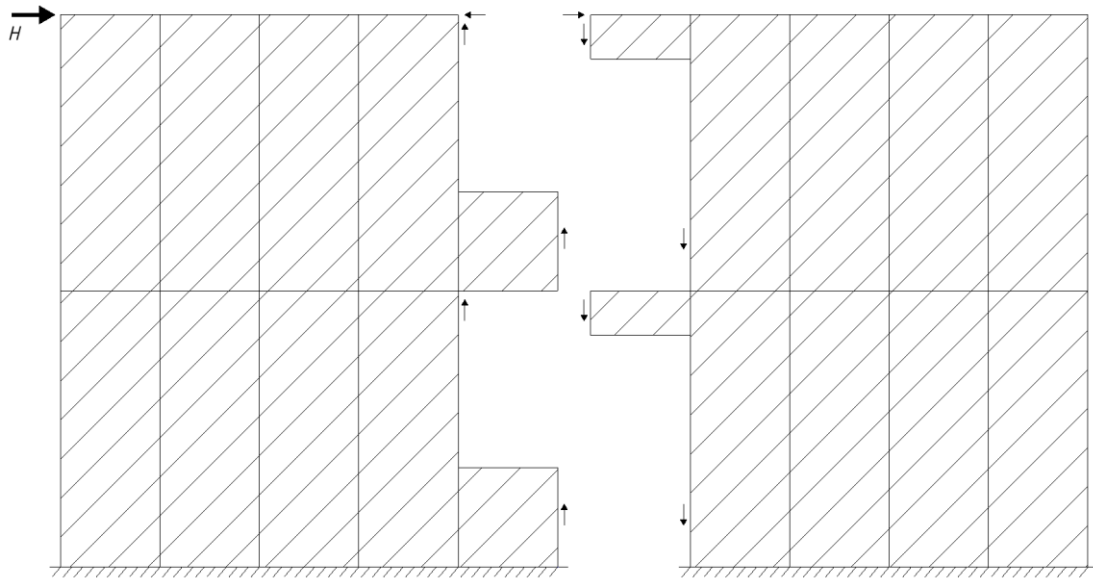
Tvåplansvägg med väggöppning belastad av vindlast på båda plan
